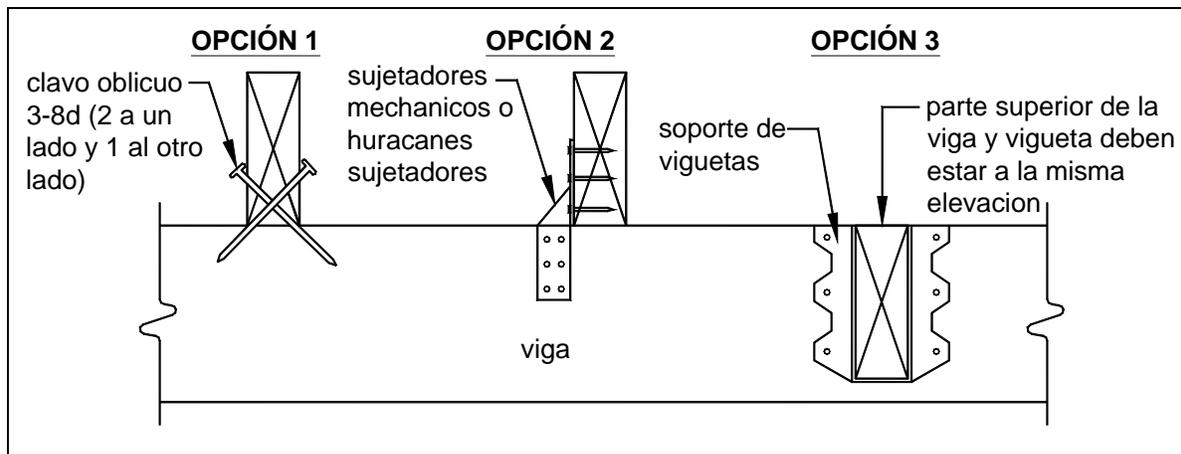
DETALLE DE LA UNIÓN DE LA VIGUETA CON LA VIGA
